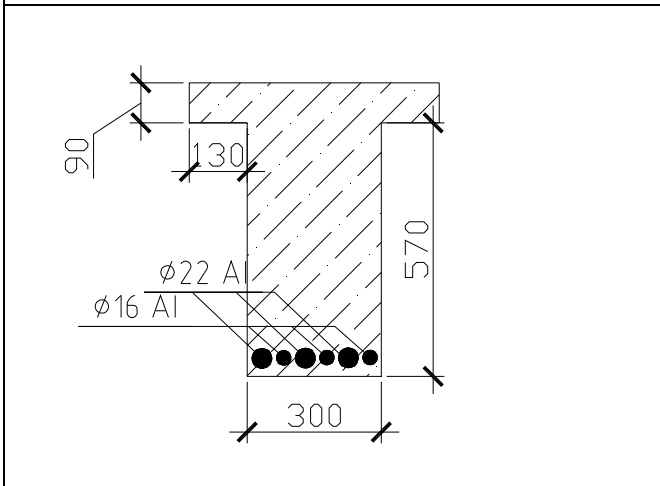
Главная балка ж/б перекрытия над третьим этажом в осях «3–7/В–Е»
